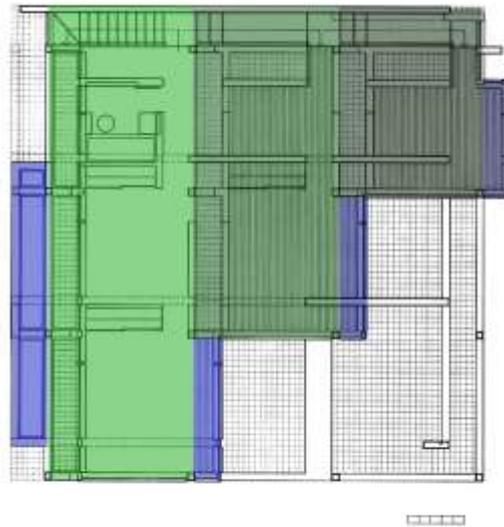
House II, planta com a transformação dos elementos arquitectónicos
